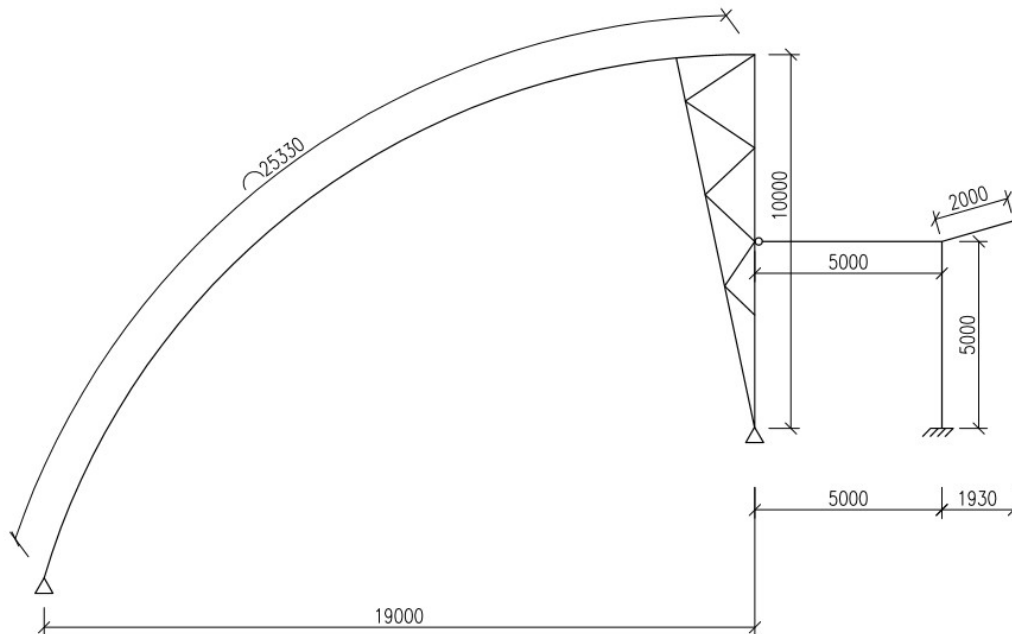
Schématický půdorys konstrukce autobusového nádraží
